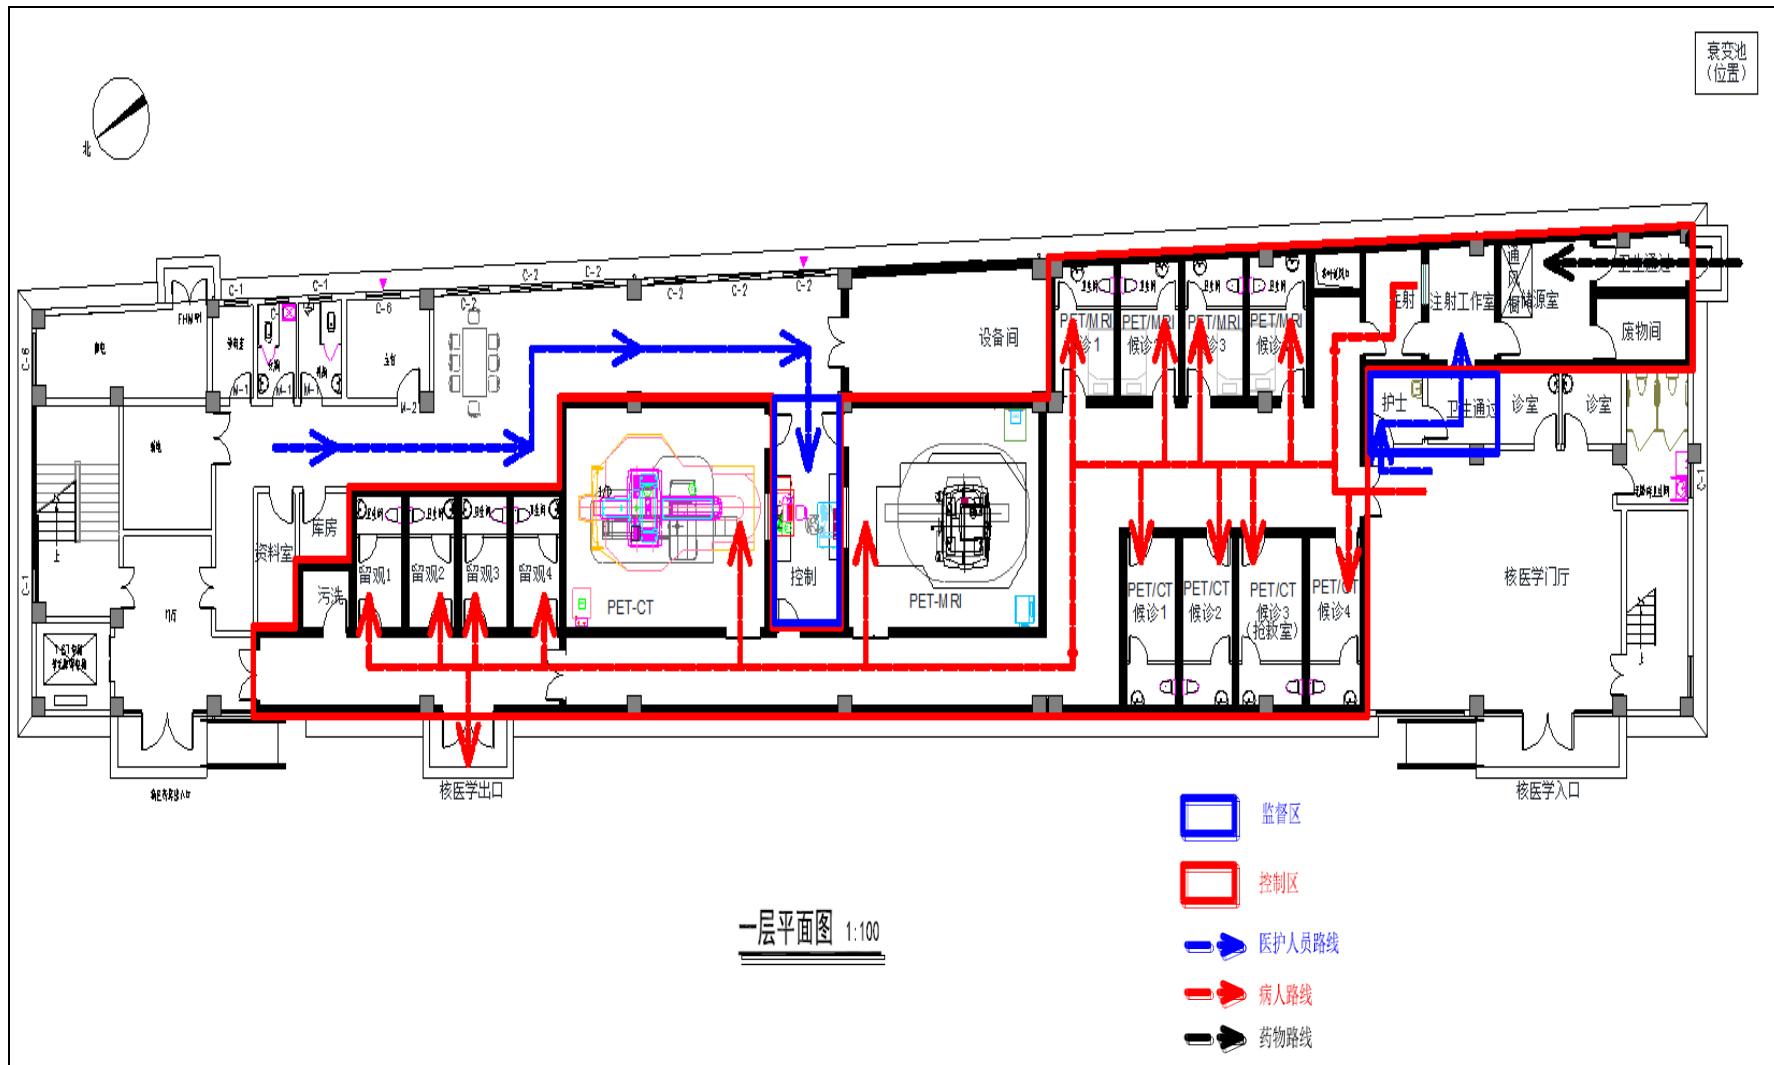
南通瑞慈医院有限公司 PET/CT 工作场所平面布置示意图
